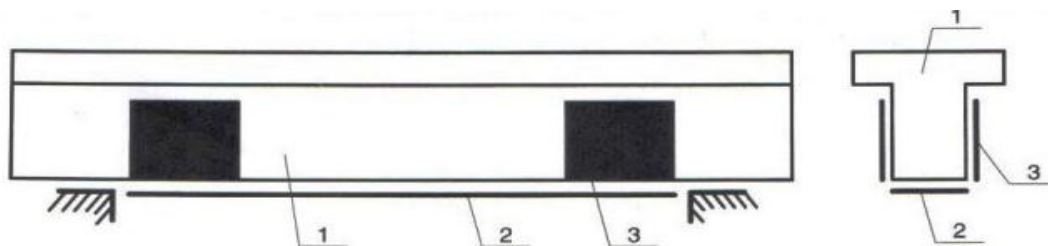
Принципиальная схема усиления железобетонной балки композитными материалами: 1 – балка; 2 – продольная накладка; 3 – вертикальные хомуты из композита
